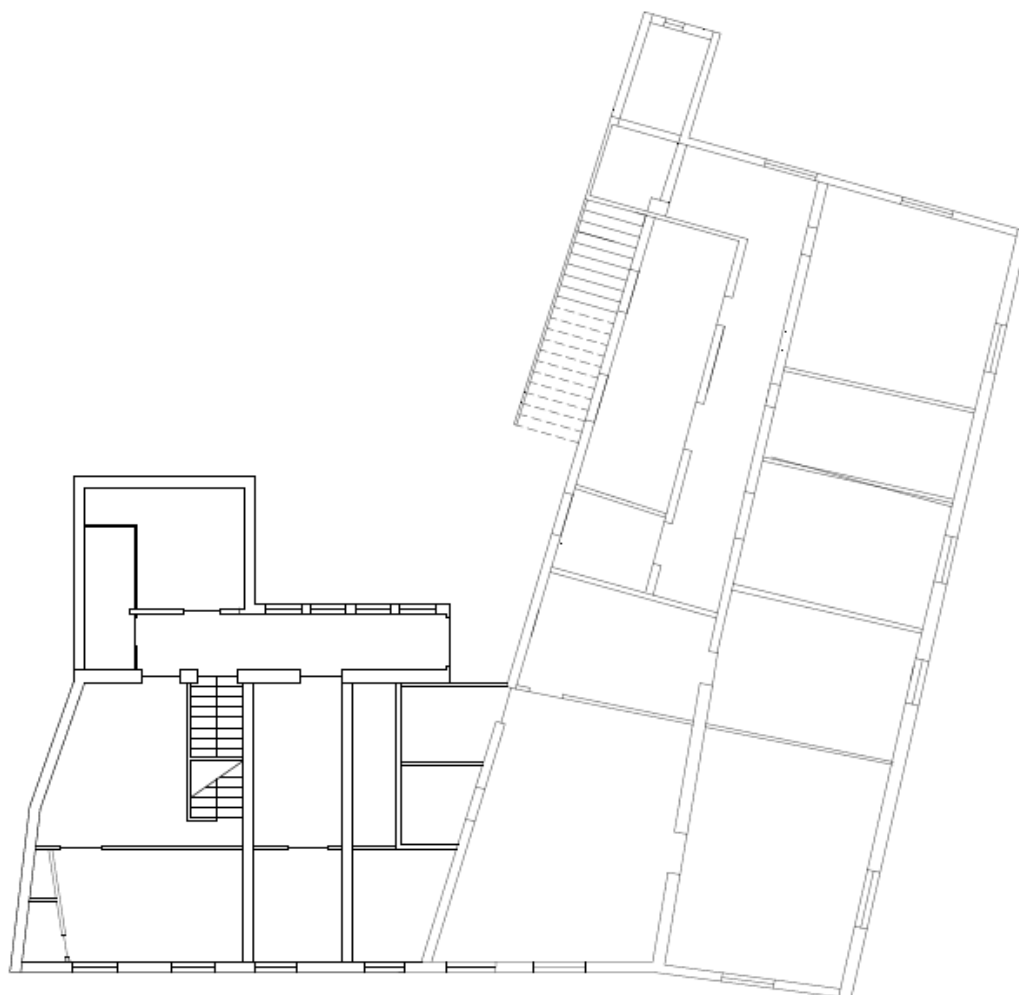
Planta do 1ºAndar (voltada a nascente)
